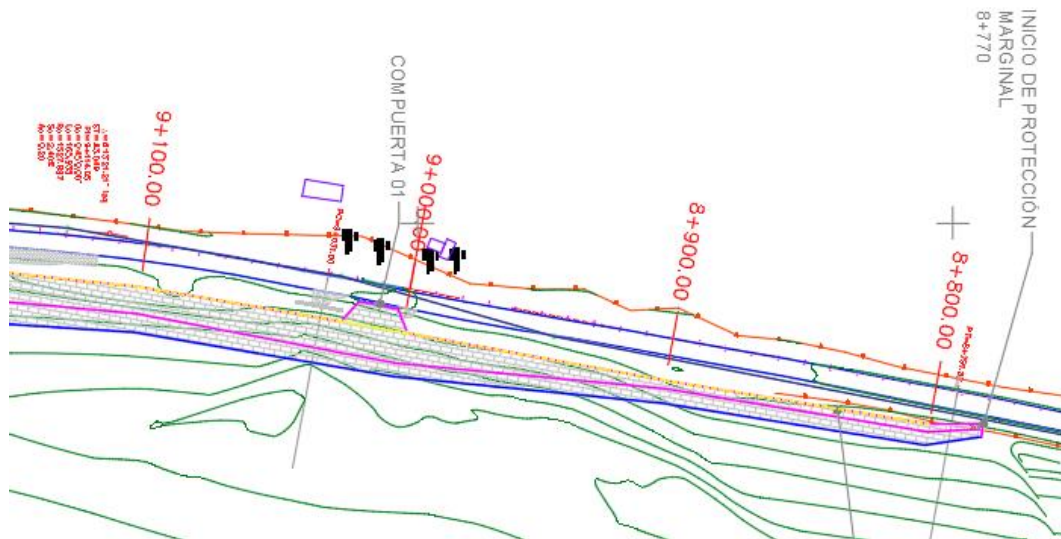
Vista en planta de la representación en planta de la protección marginal.
